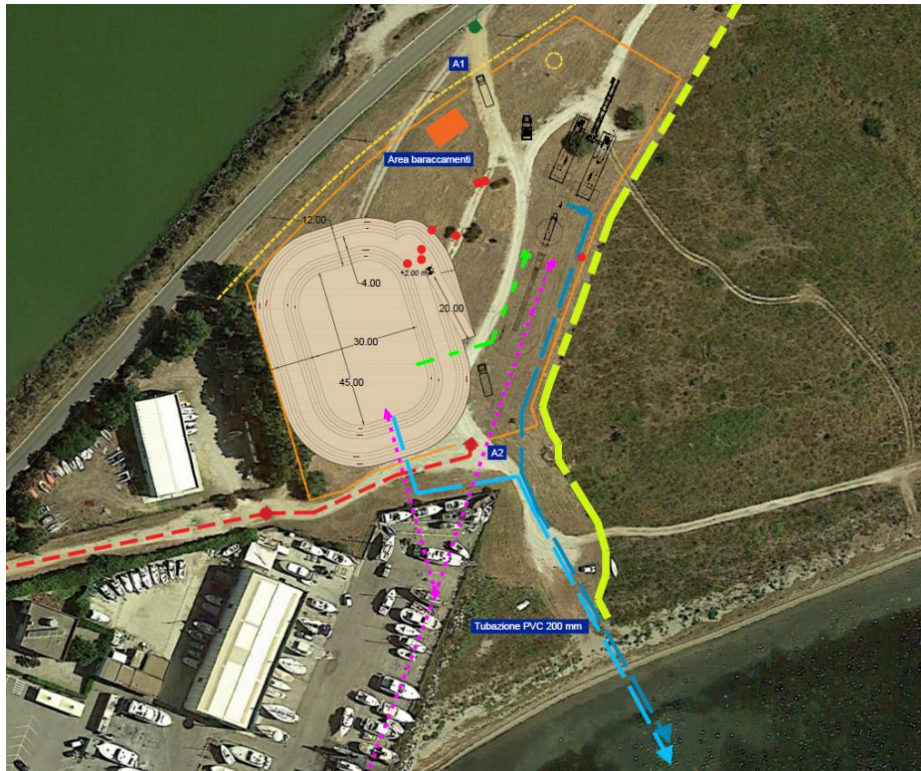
Dettaglio dell'area di cantiere a terra destinata a vasche di colmata e impianto di trattamento delle materie provenienti dagli escavi prevista nelle aree esterne adiacenti al porto secondo la Soluzione 2.
